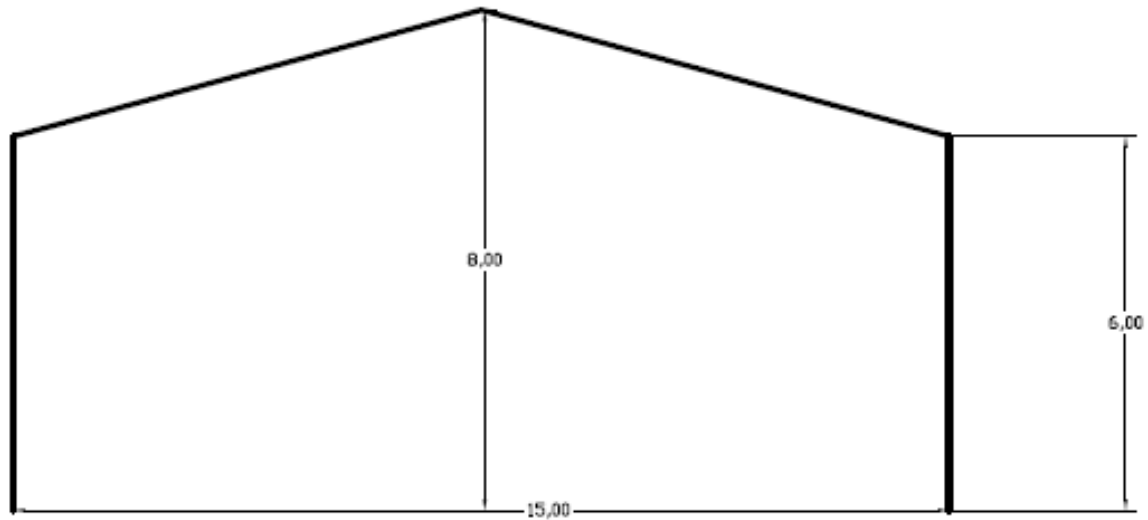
Croquis de las dimensiones de los pórticos metálicos que componen la estructura de la nave.
